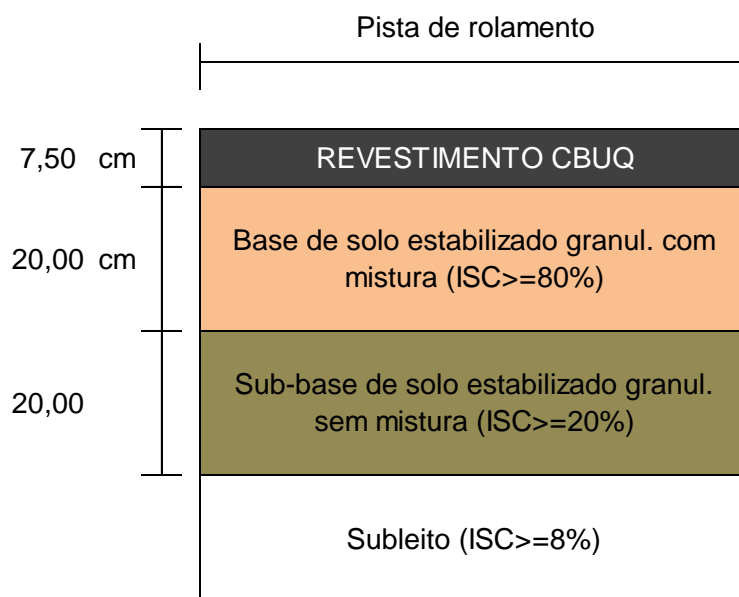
Estrutura de pavimento método DNER/DNIT.
